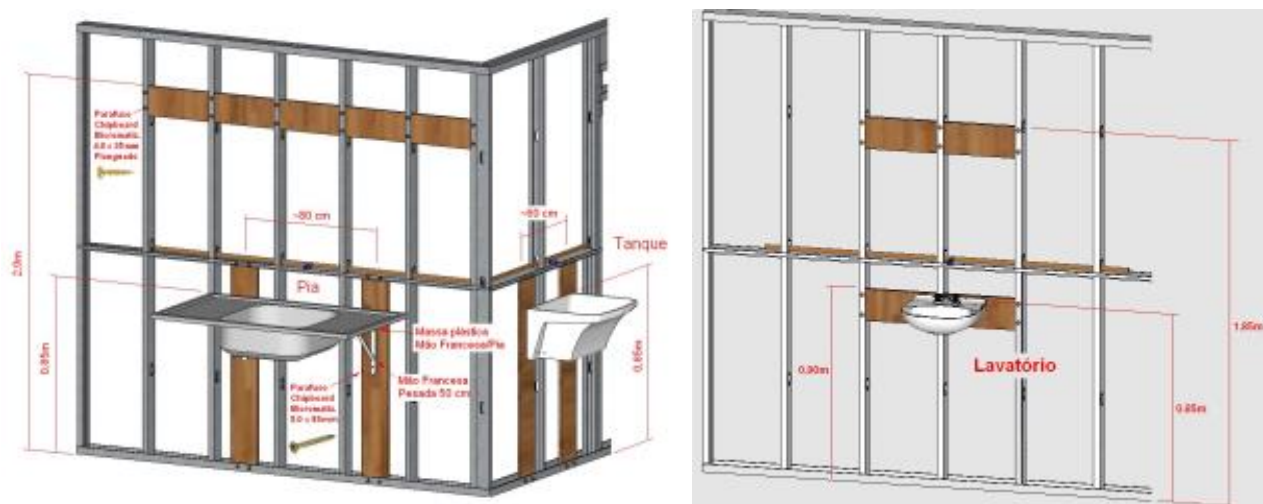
Reforços em madeira para fixação de peças suspensas (pia e armários).
